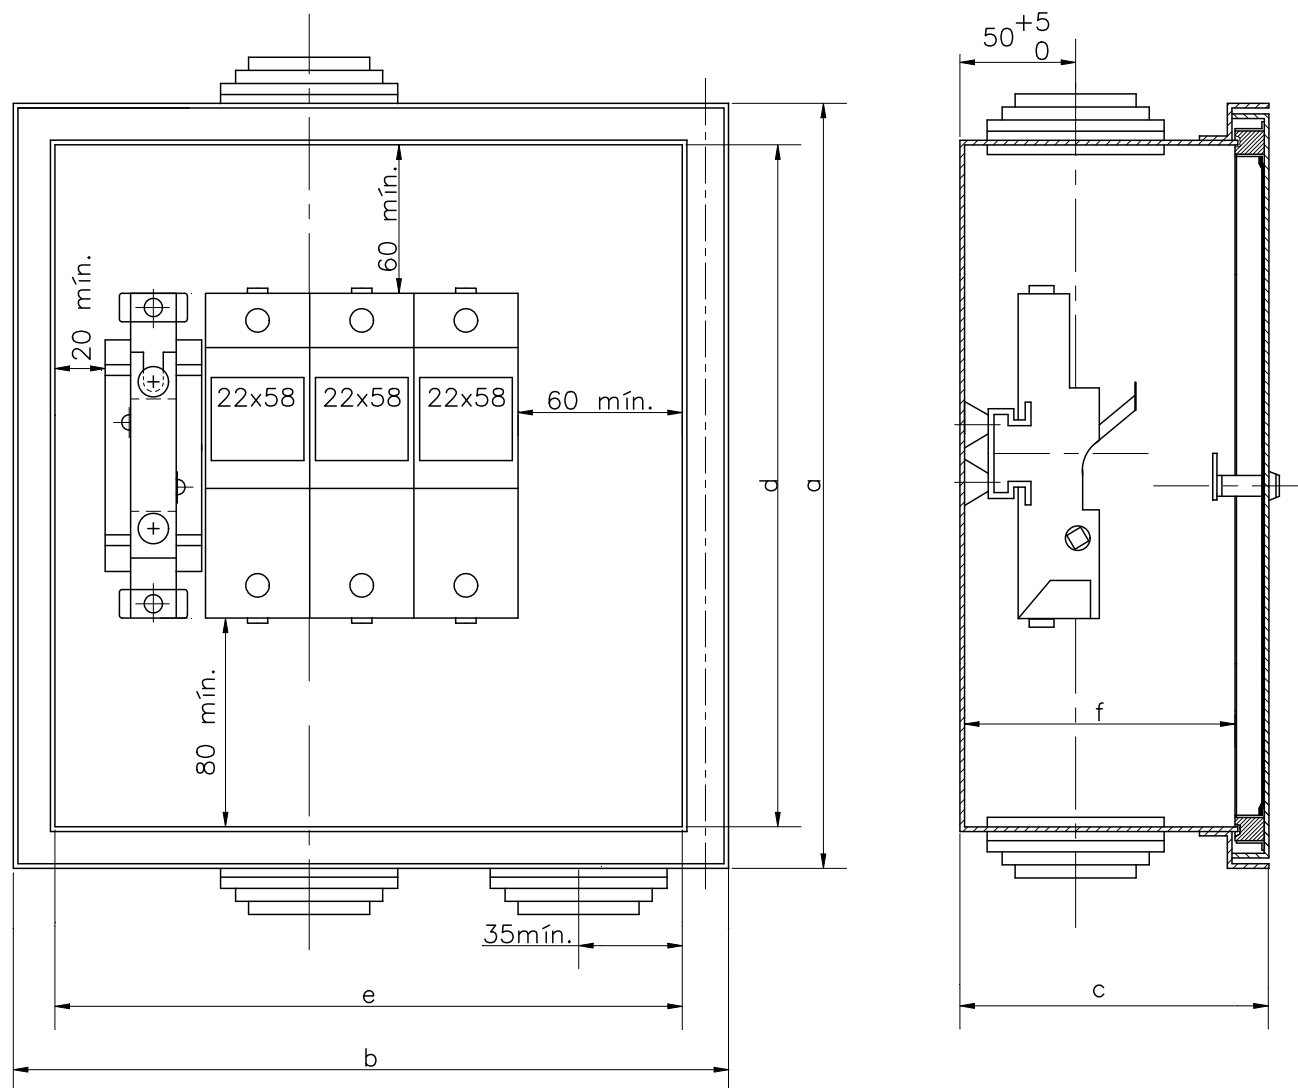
Portinhola P100 – Disposição e dimensões
